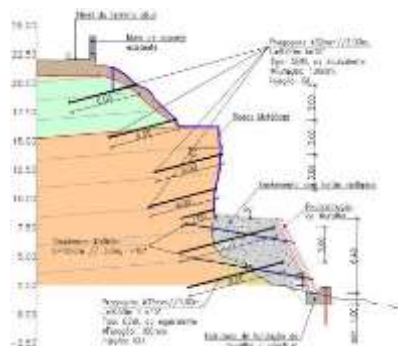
Corte tipo e exemplo de reconstrução de muralha com pedra argamassada
